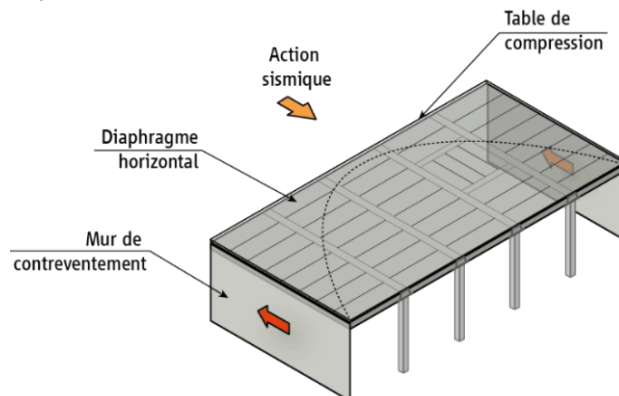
Fonctionnement en diaphragme horizontal d'un plancher avec poutres Deltabeam
